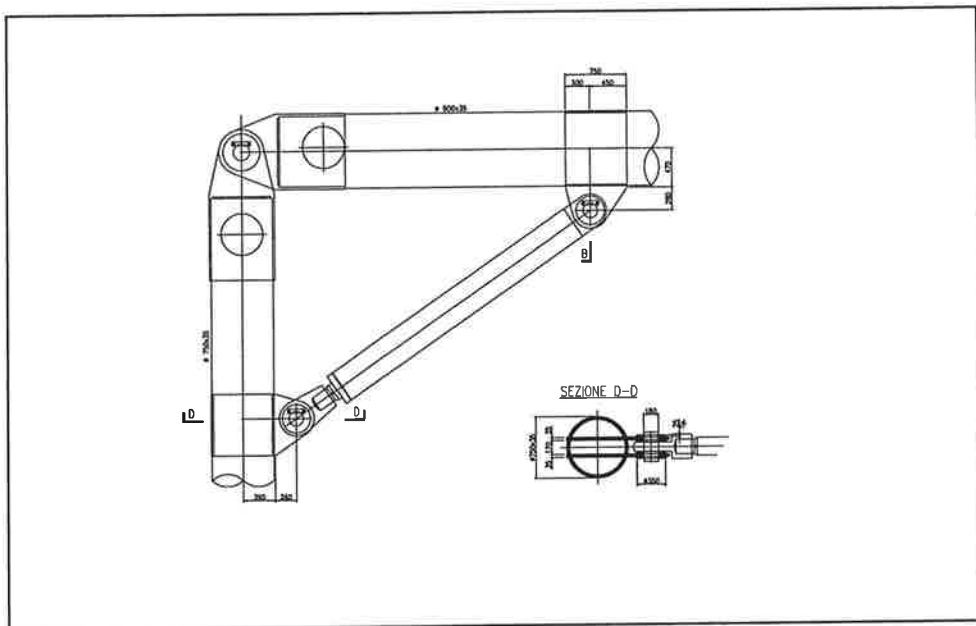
DETTAGLI CERNIERE MARTINETTO
